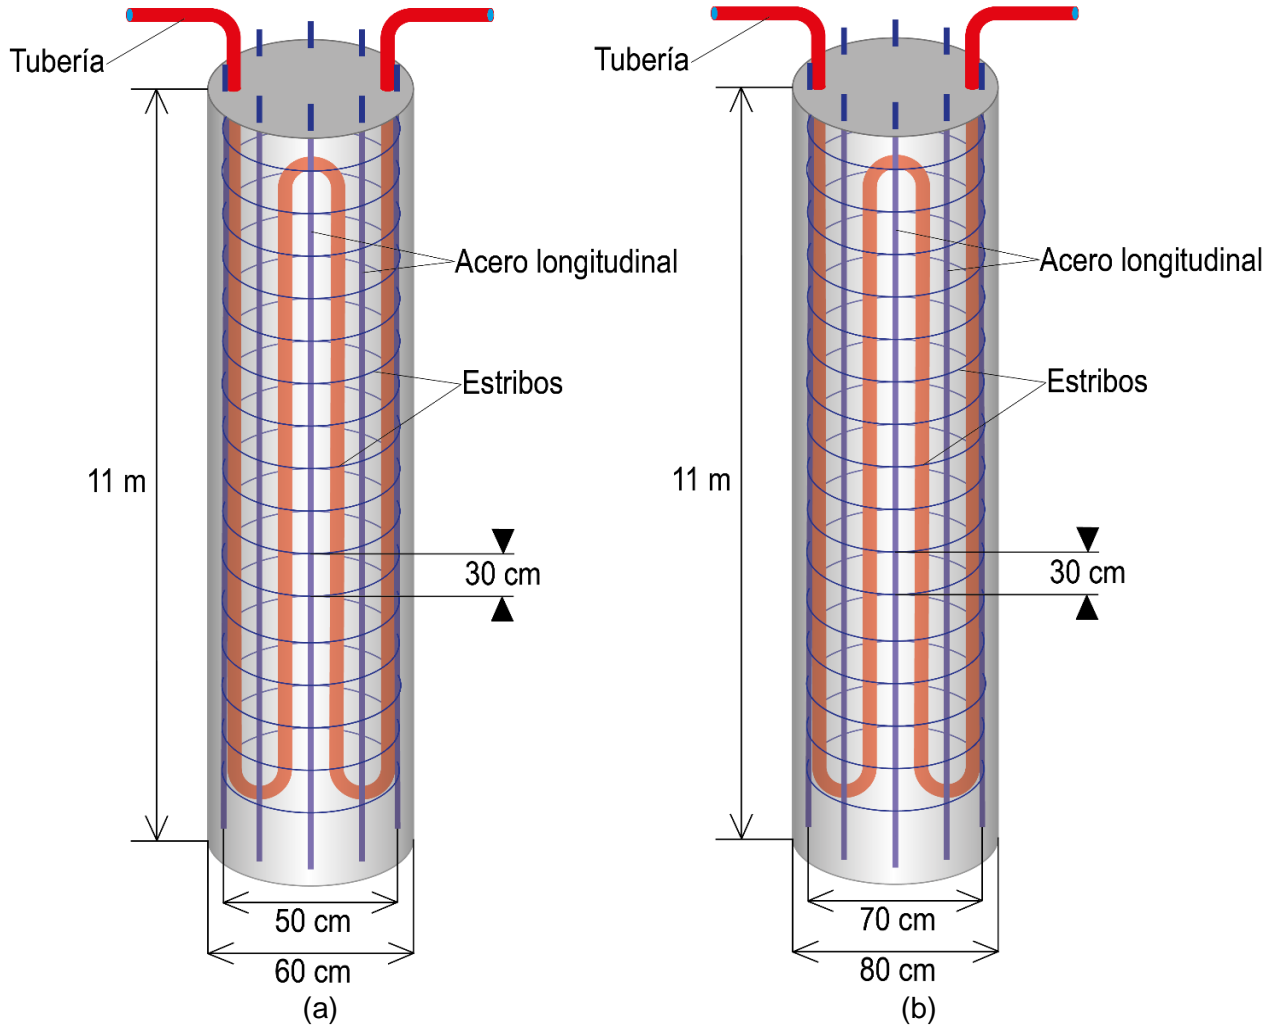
Esquema longitudinal de pila de energía con tubería en W: (a) 60 cm de diámetro y (b) 80 cm de diámetro
